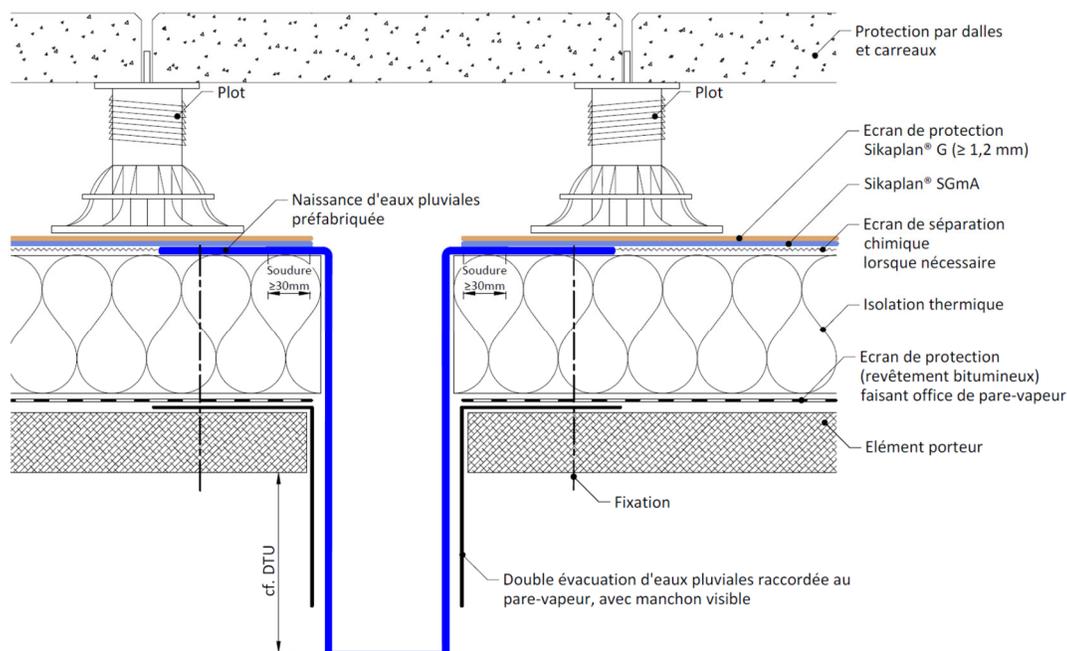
Entrée d'eaux pluviales avec moignon cylindrique préfabriqué en PVC rigide et dispositif par double EEP
